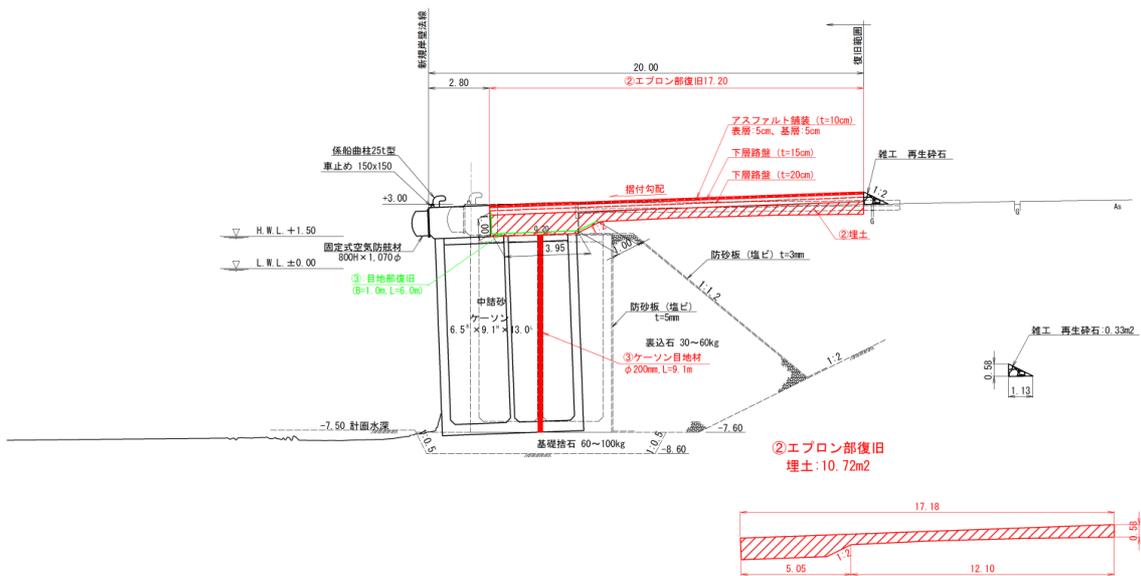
No.6 日立港区_第2ふ頭地区 2-C 岸壁 (-7.5m) の断面図 No.2 (復旧後)
